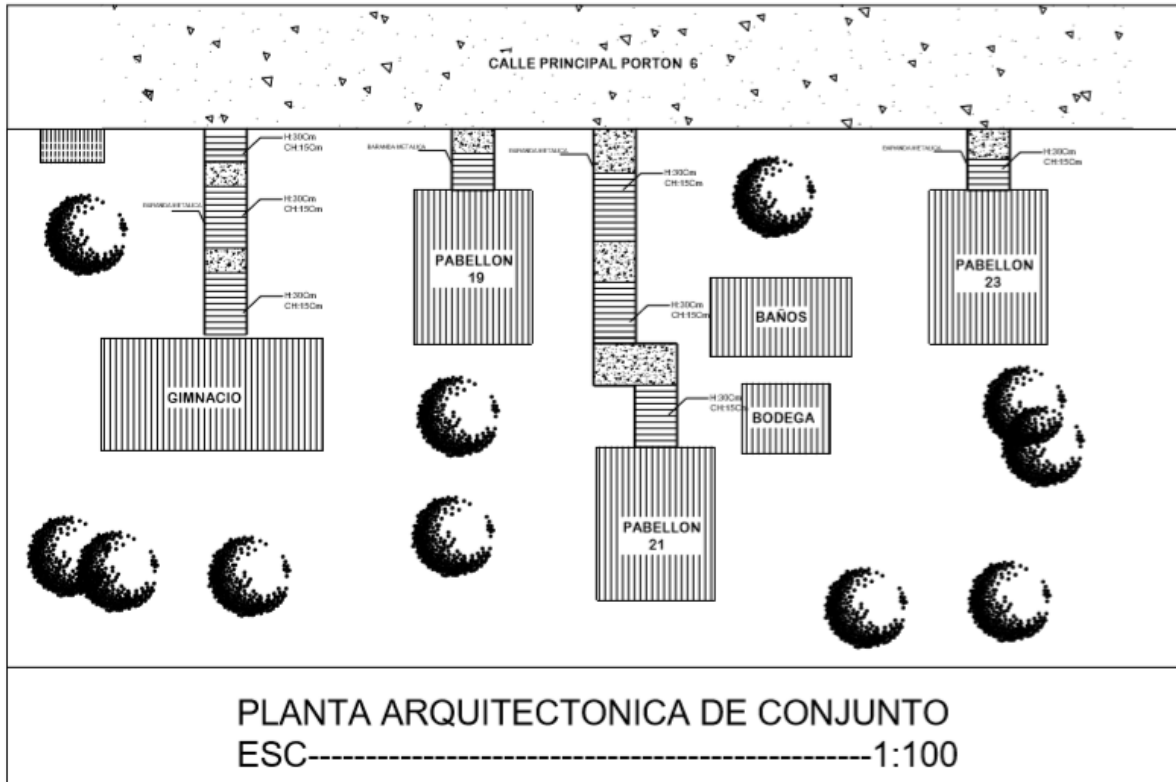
Propuesta de Plan arquitectónico de Escaleras zona 1, Recinto Universitario "Rubén Darío".
